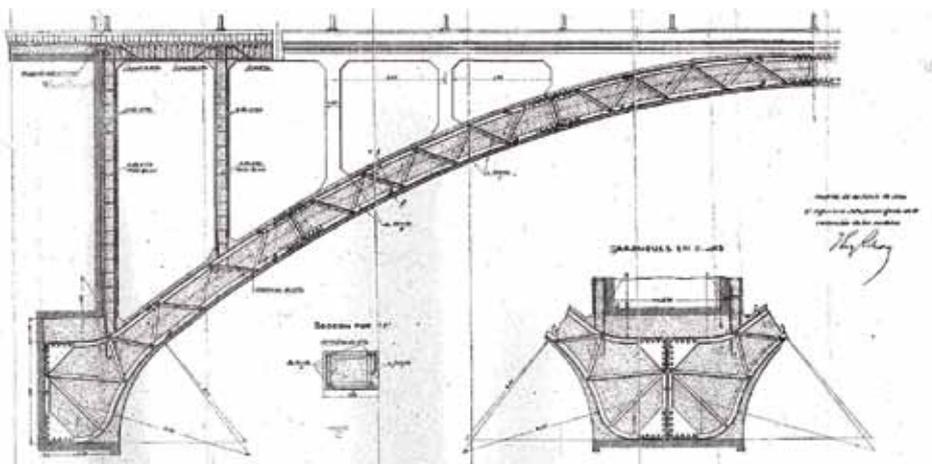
Plano de puente arco de 25 m de luz rebajado al 1/4 de la colección de modelos de puentes de hormigón armado de J. E. Ribera
